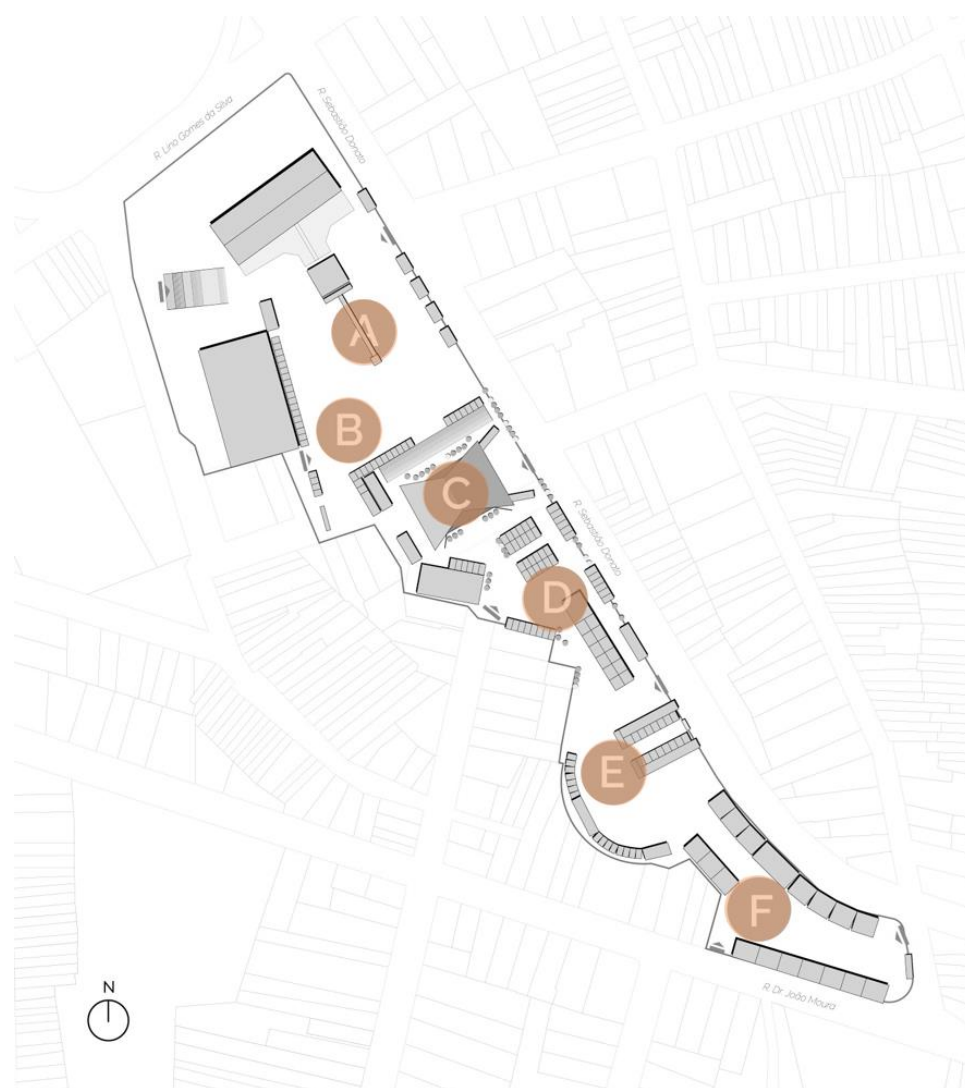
Mapa Parque do Povo - Layout 2017. Acervo LabRua, 2018.
